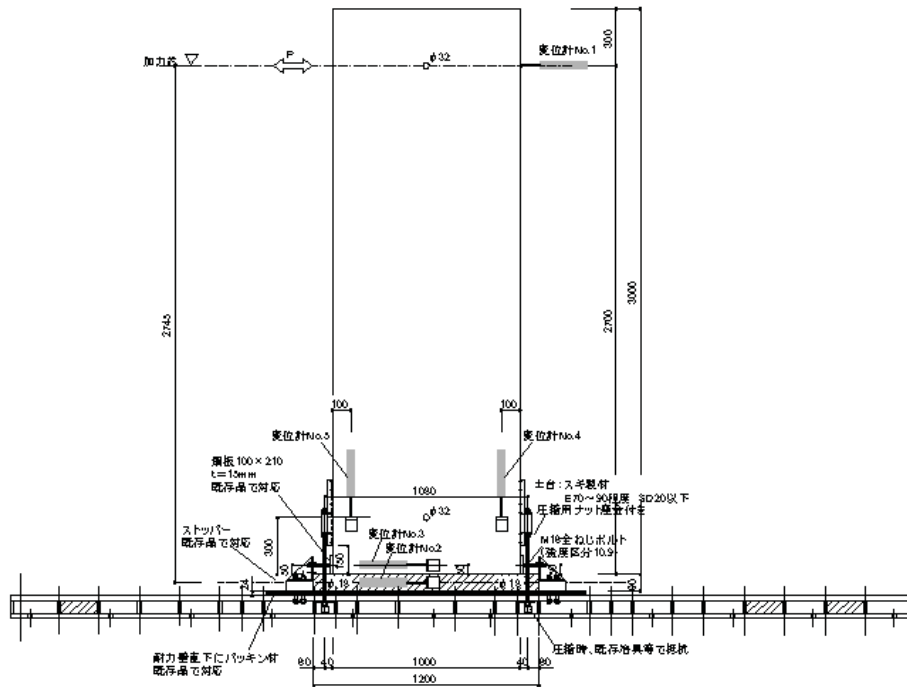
HD 金物(1m 幅耐力壁：ラミナ割り付け 103+29) 試験体立面図(HD1-3)
